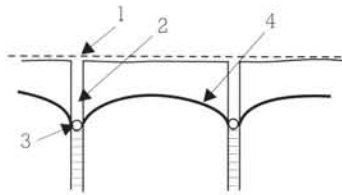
Schéma du rabattement d'une nappe libre par des puits.
